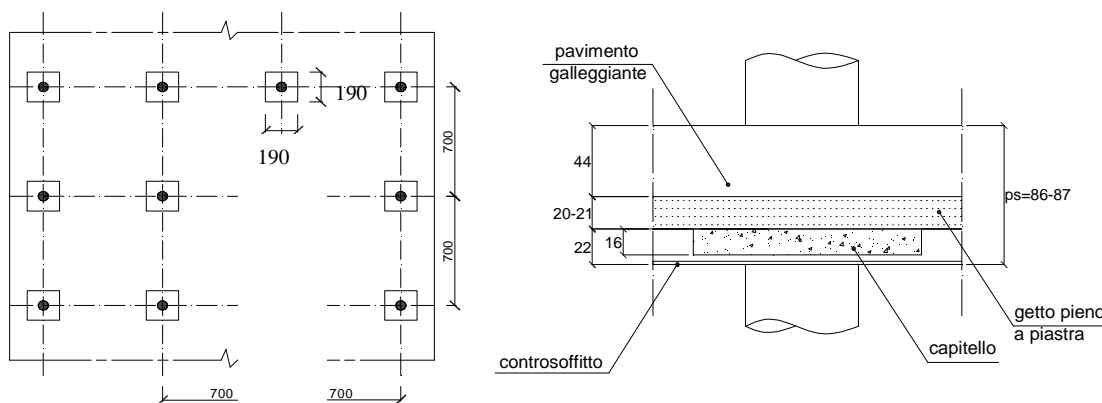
ne n.°2 in NSC, pianta di piano e sezione impalcato
